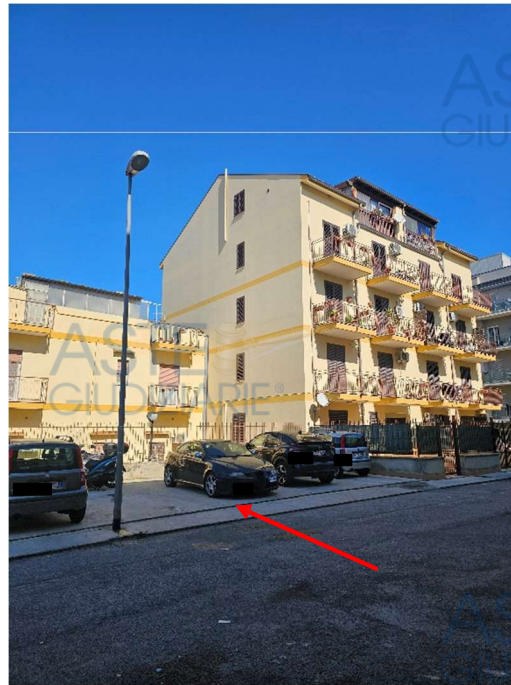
vista del prospetto laterale, con la freccia l'area vincolata a parcheggio dove insiste il posto auto di uso esclusivo
